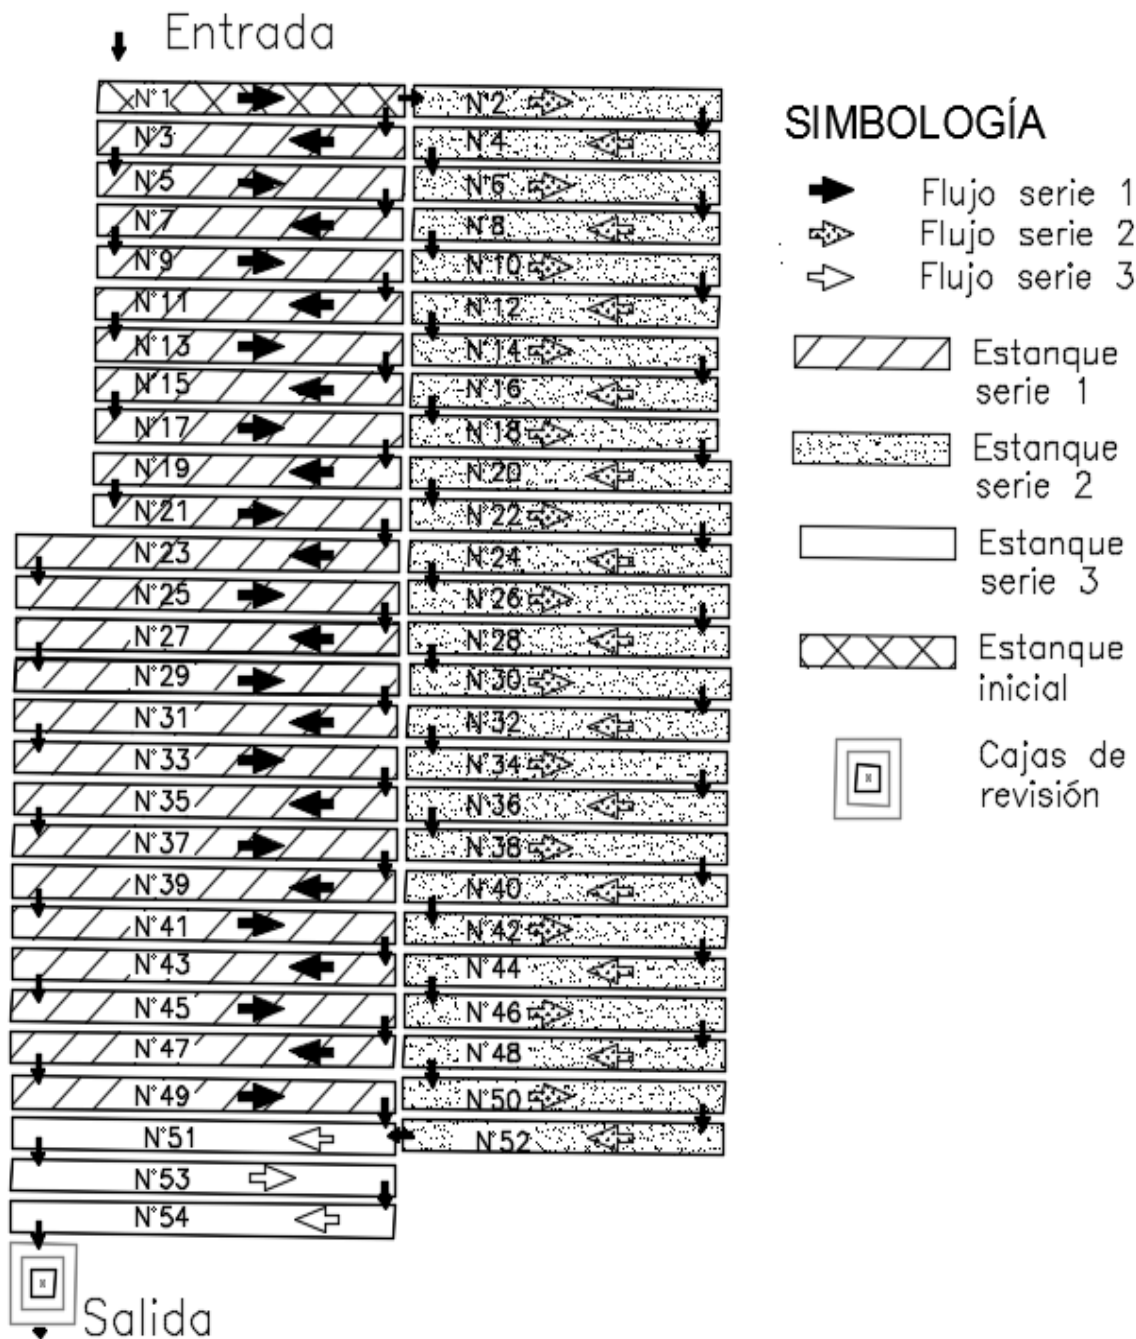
Vista en planta de los estanques con macrófitas flotantes. Planta N°14. Basado en Moscoso (2006).
